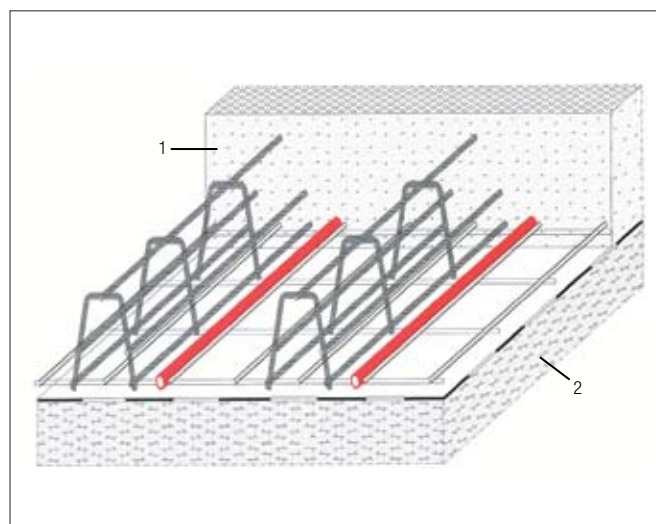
Placă de pardoseală armată cu pat de oțel; construcție standard – țevile de încălzire montate central în placă
